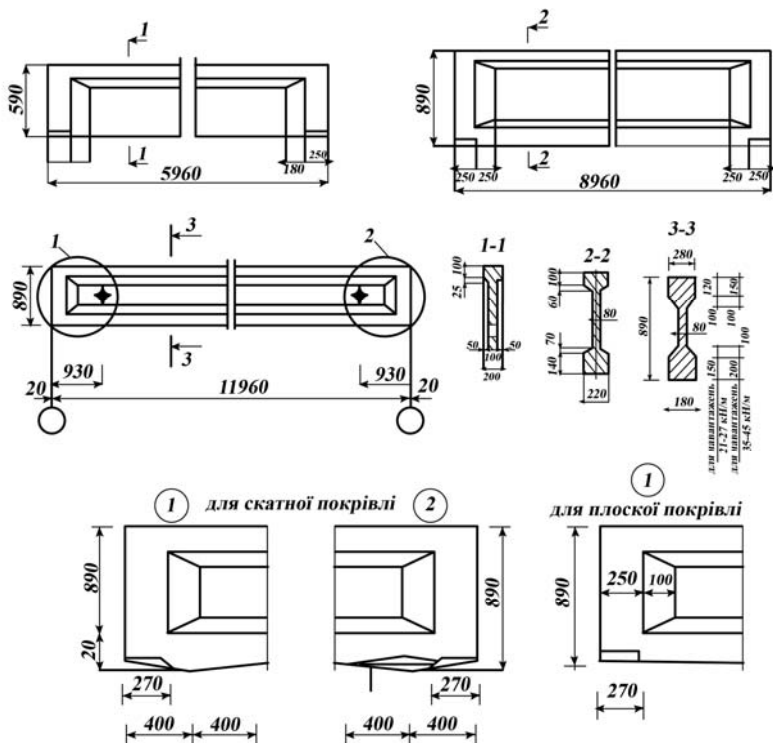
Залізобетонні балки: з паралельними поясами прольотами 6, 9, 12 м для плоских покриттів
